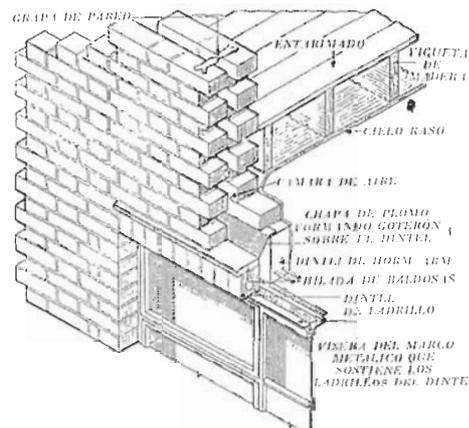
El cavity wall según "la construcción moderna" de Warland, editado en España en 1947.
